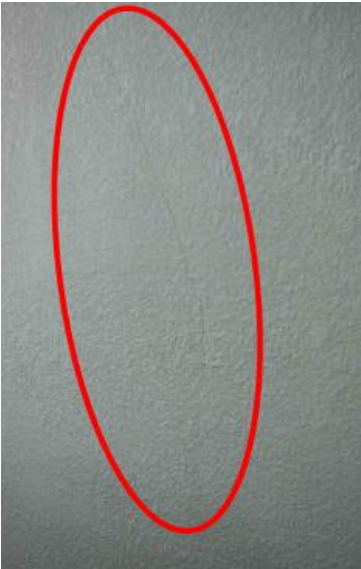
Grietas verticales que atraviesan muros interiores
